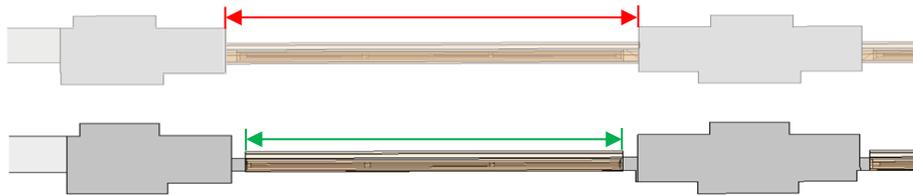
Interpretationsansätze eines Fensterelements im Grundriss (oben: Fensterrahmen zu breit angenommen, unten: Konstruktiv korrekte Zuordnung).
